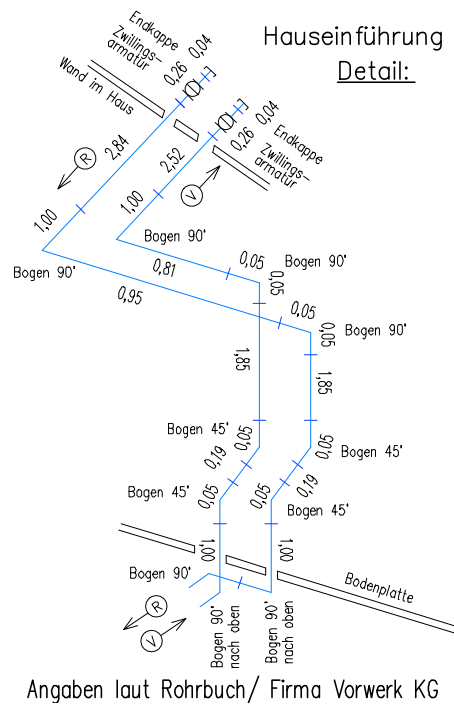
Hauseinführung Siedeln im Grundbau
